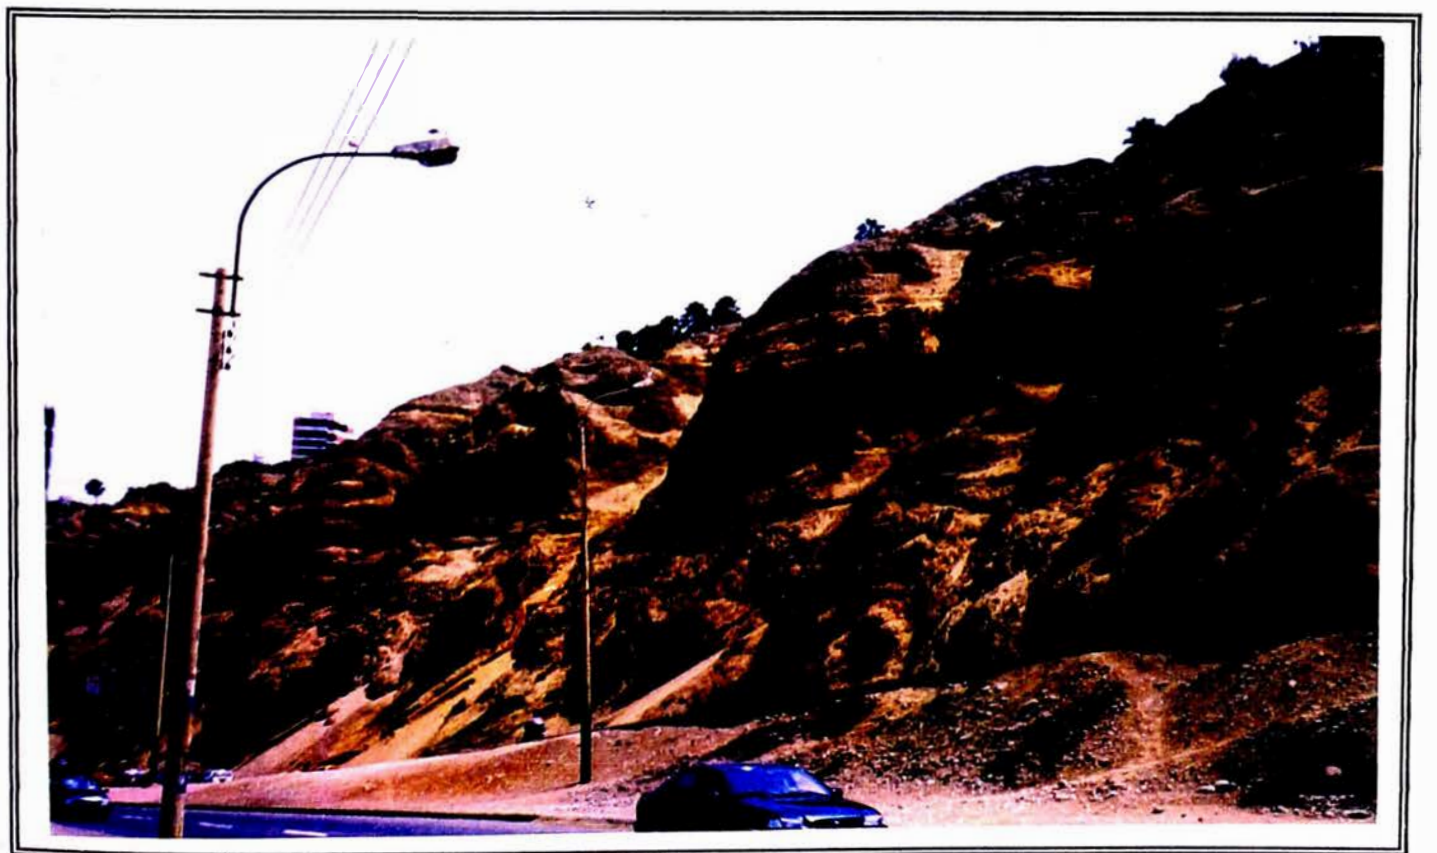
Detalle de los taludes de la Quebrada de Armendáriz
